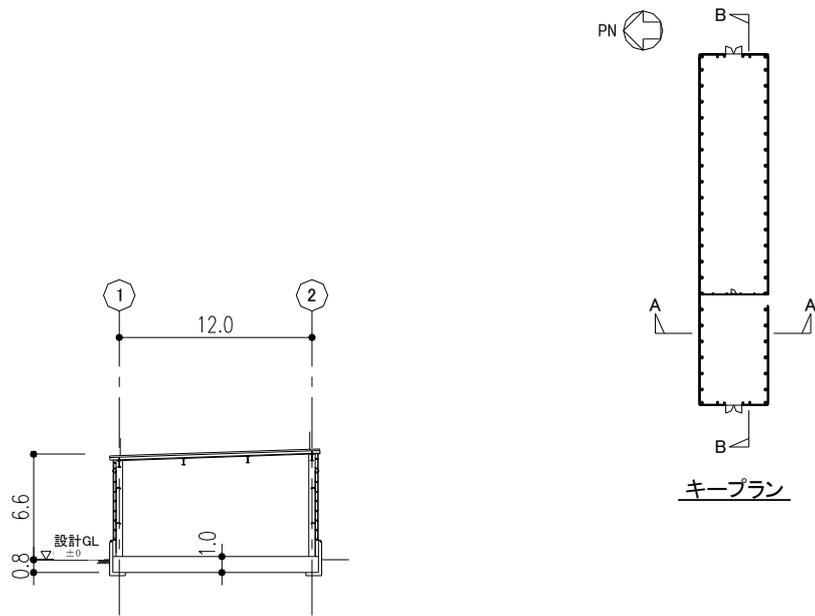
設備棟 A-A断面図 (NS方向) (単位:m)
